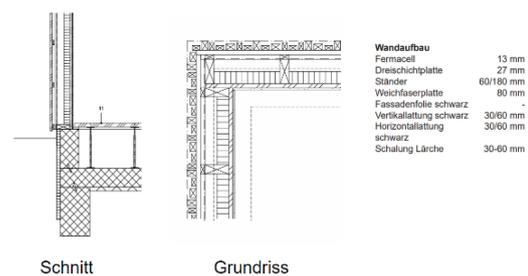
Grundriss und Schnitt des Fassadenaufbaus
